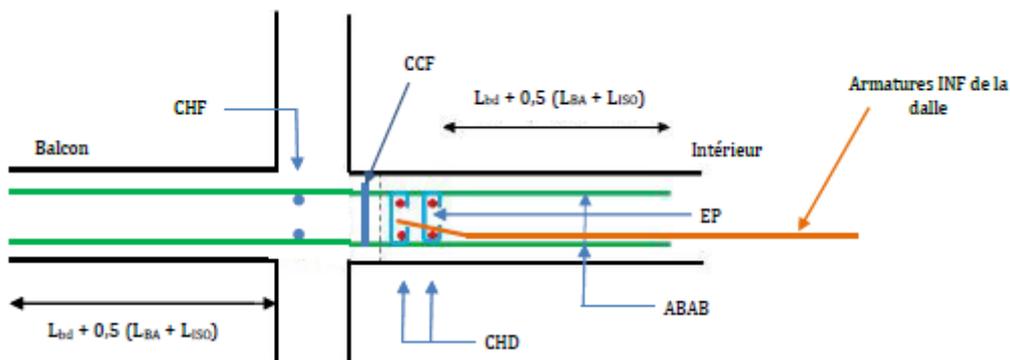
Exemples de dispositions constructives au droit d'une bande d'appui en zone de balcons
